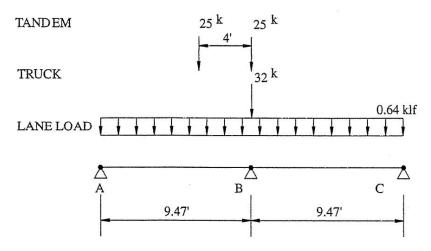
Posición crítica de carga viva para reacciones en vigas de piso intermedias
